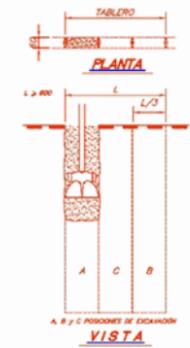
MURO MILÁN TIPO CON EXCAVACIÓN EN 3 POSICIONES POR MÓDULO
